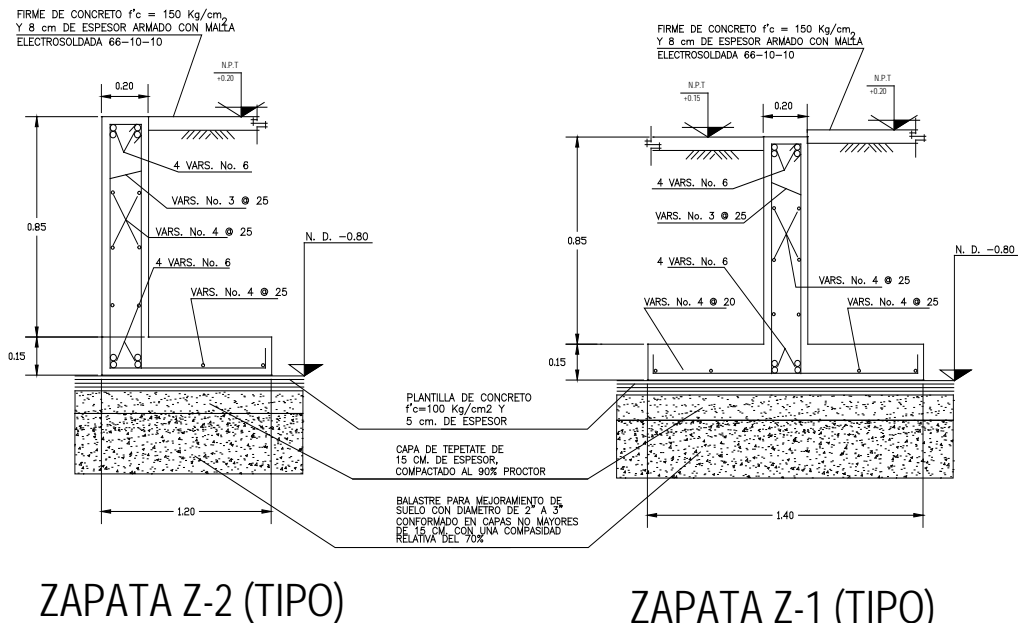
Vista en corte de las zapatas corridas y de sus especificaciones para construcción.
